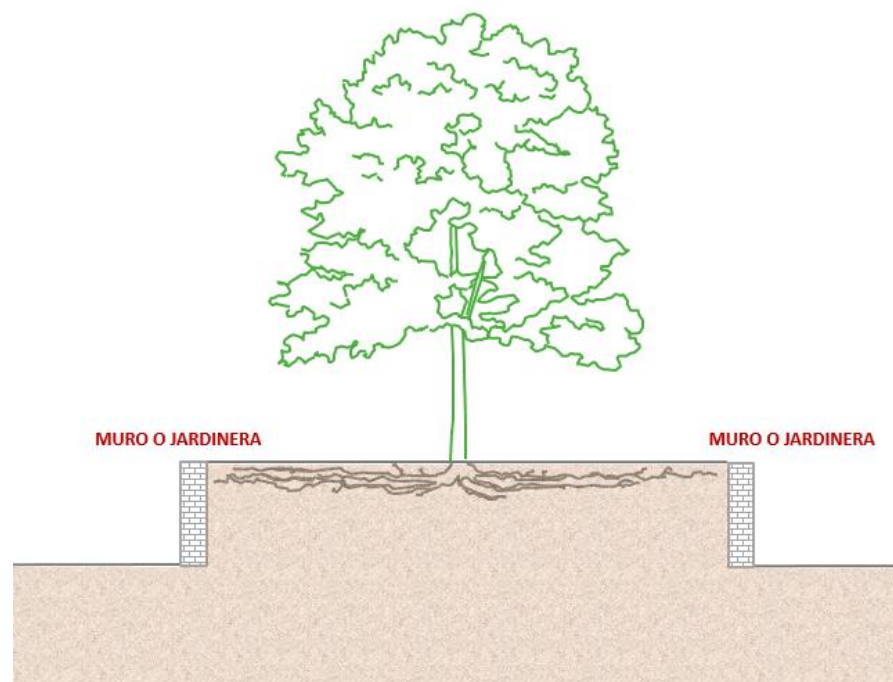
para proteger al árbol de un rebaje del terreno se debe construir un muro o jardinera.
